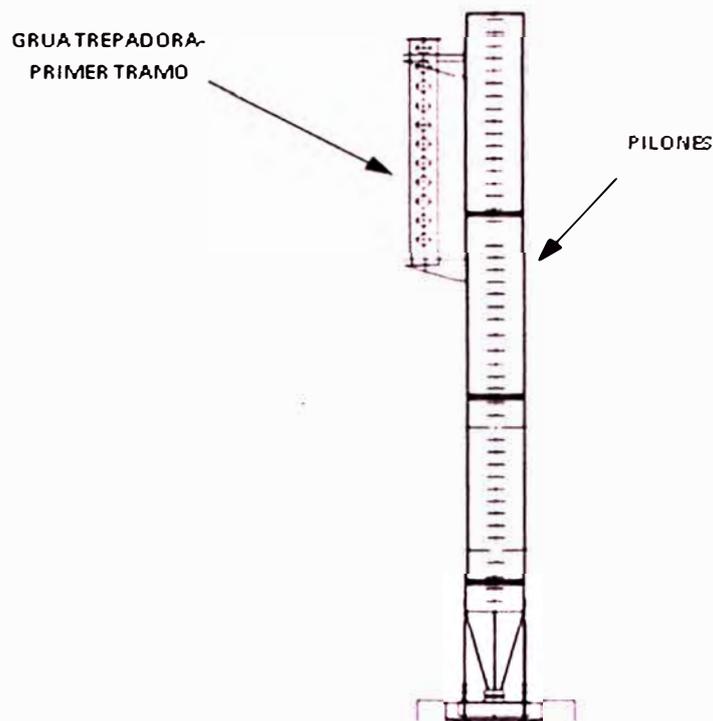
ESQUEMA MONTAJE DE GRÚA TREPADORA
